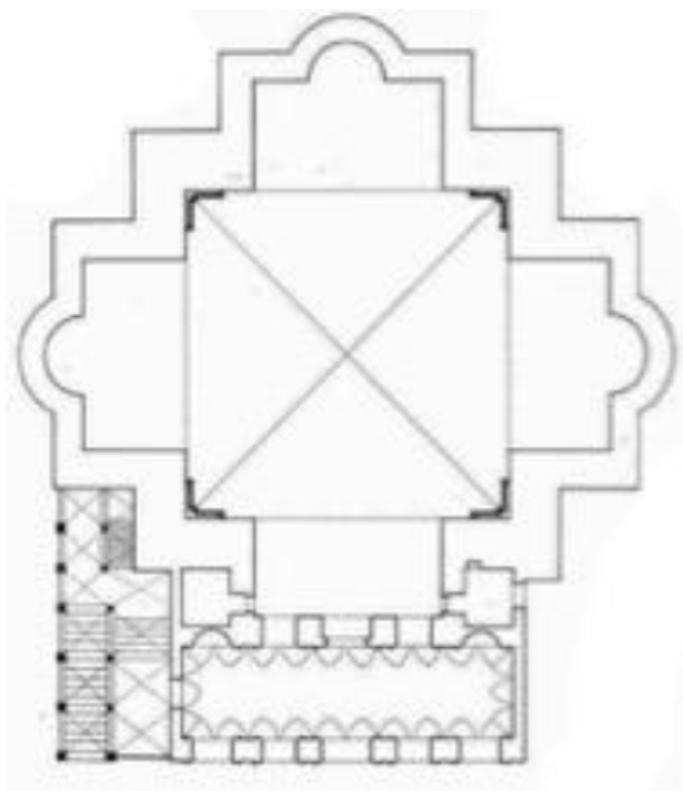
Igreja de San Sebastiano. Planta baixa.
